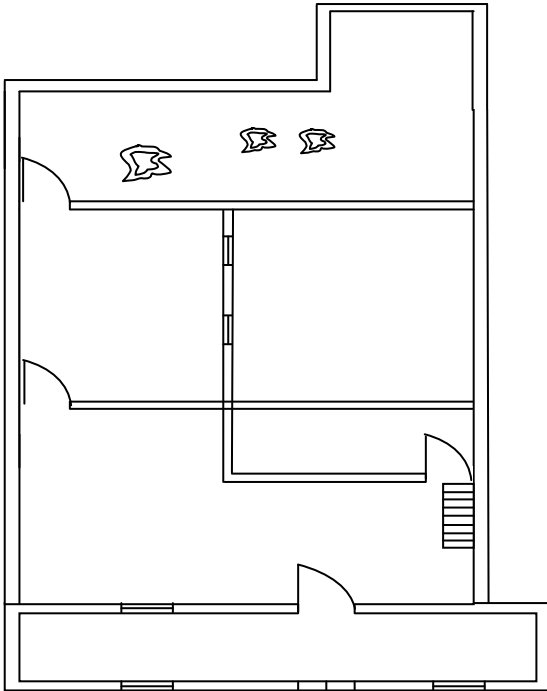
Plano de Planta casa Sra. Maria Lopez.
